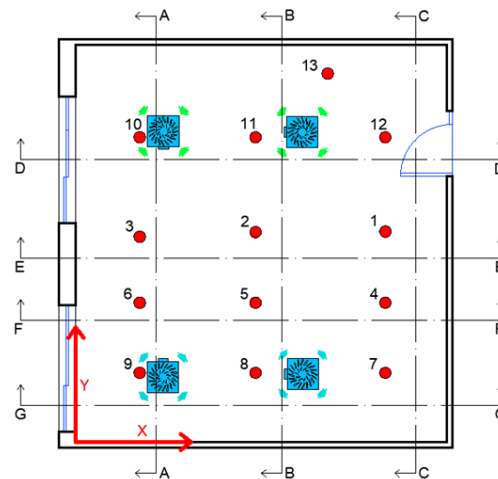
Planimetria con individuazione delle sezioni di riferimento: A-A; B-B; C-C
